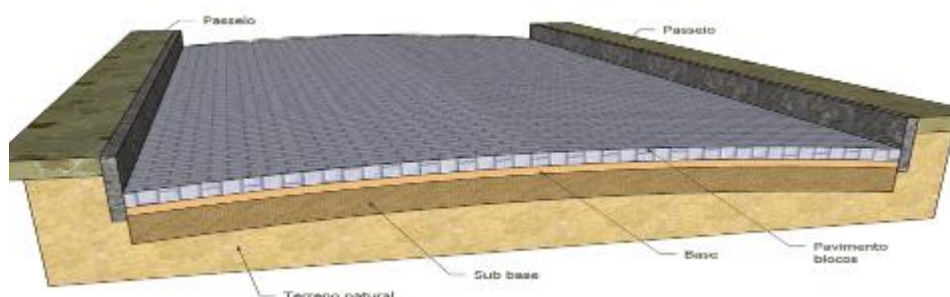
Desenho esquemático do perfil transversal da pavimentação com blocos
